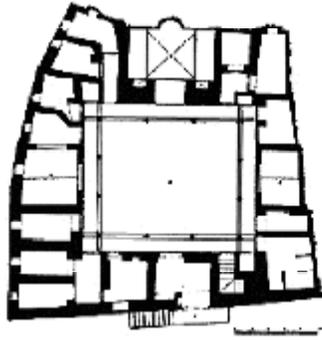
مسقط أفقي لجامع أبي محمد المرجاني بتونس، عن: عامر عجلائن؛ المرجع السابق، شكل 62.
